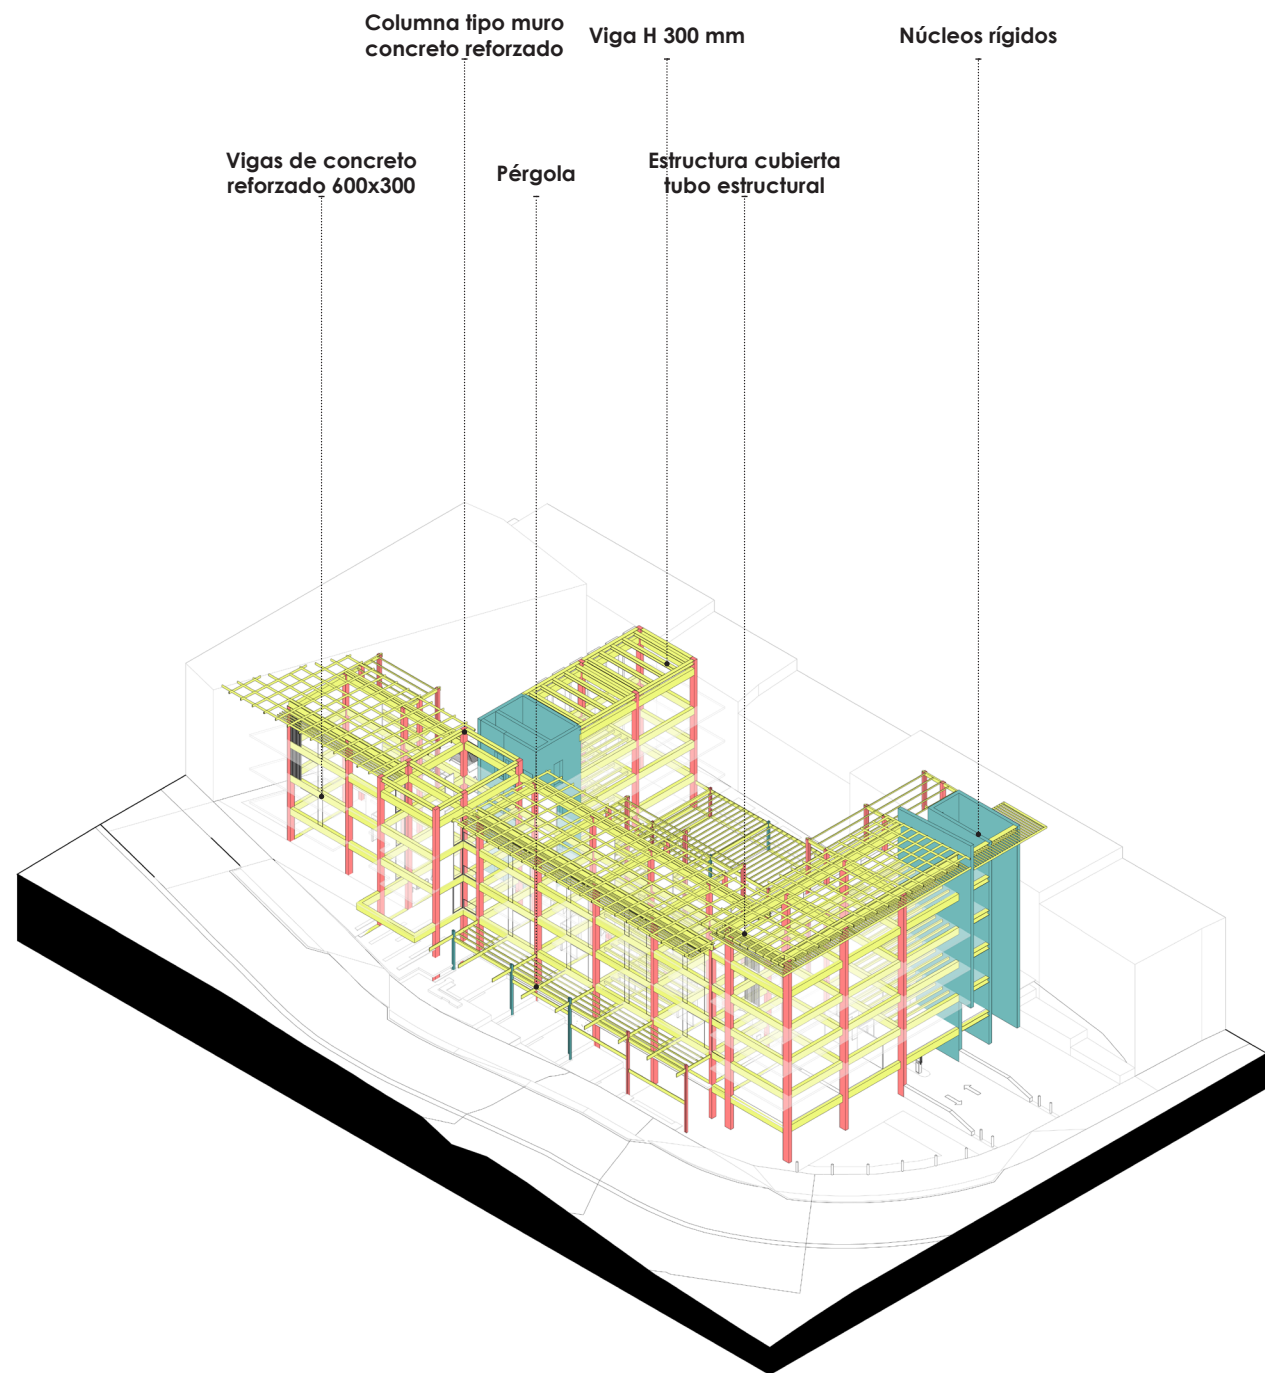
Isométrico de estructura principal. Fuente: Elaboración propia.
